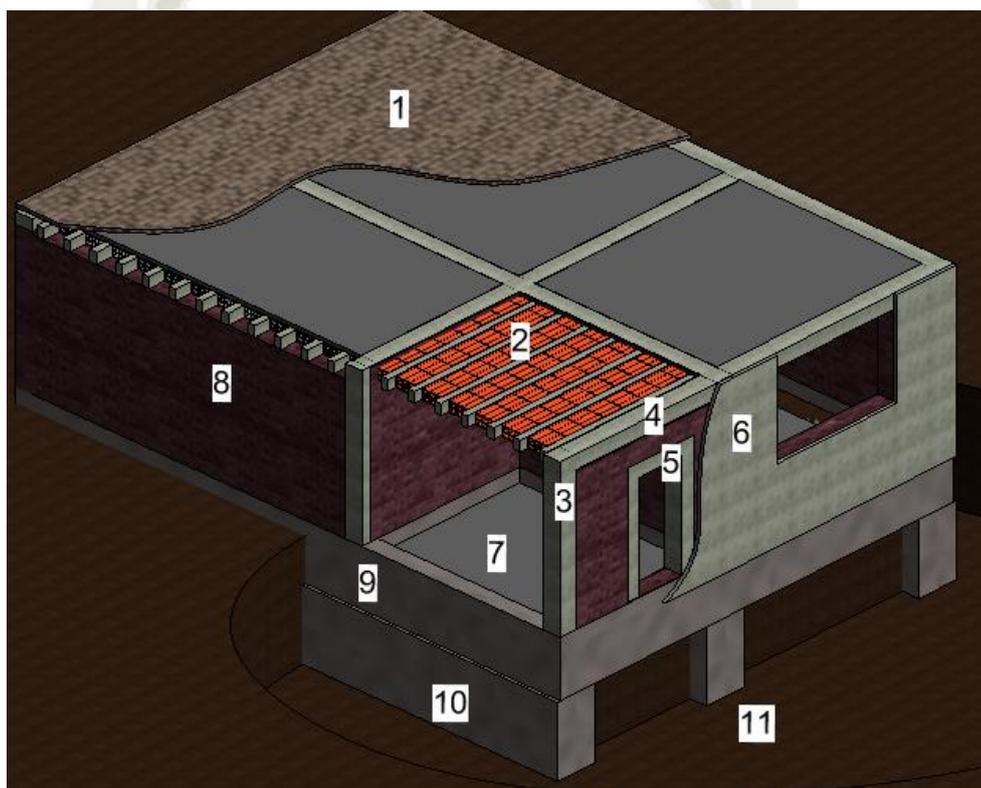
Elementos de una vivienda de Albañilería Confinada.
